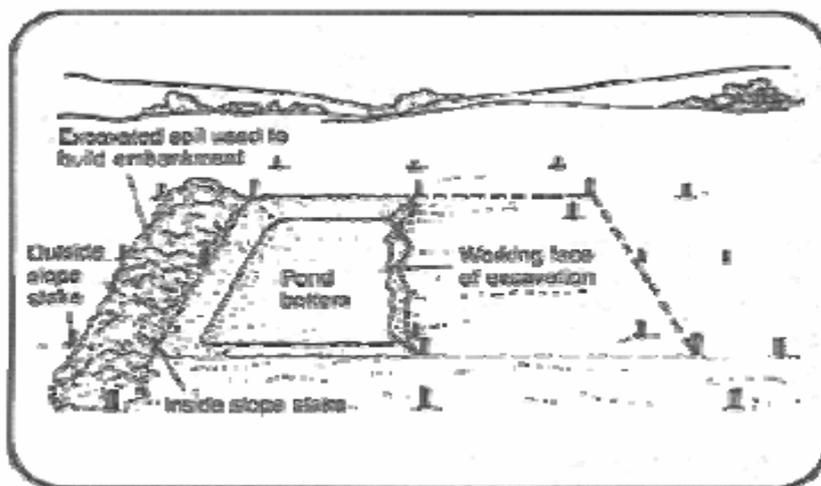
Excavación de una laguna de estabilización.(OPS/CEPIS/05.1641)
